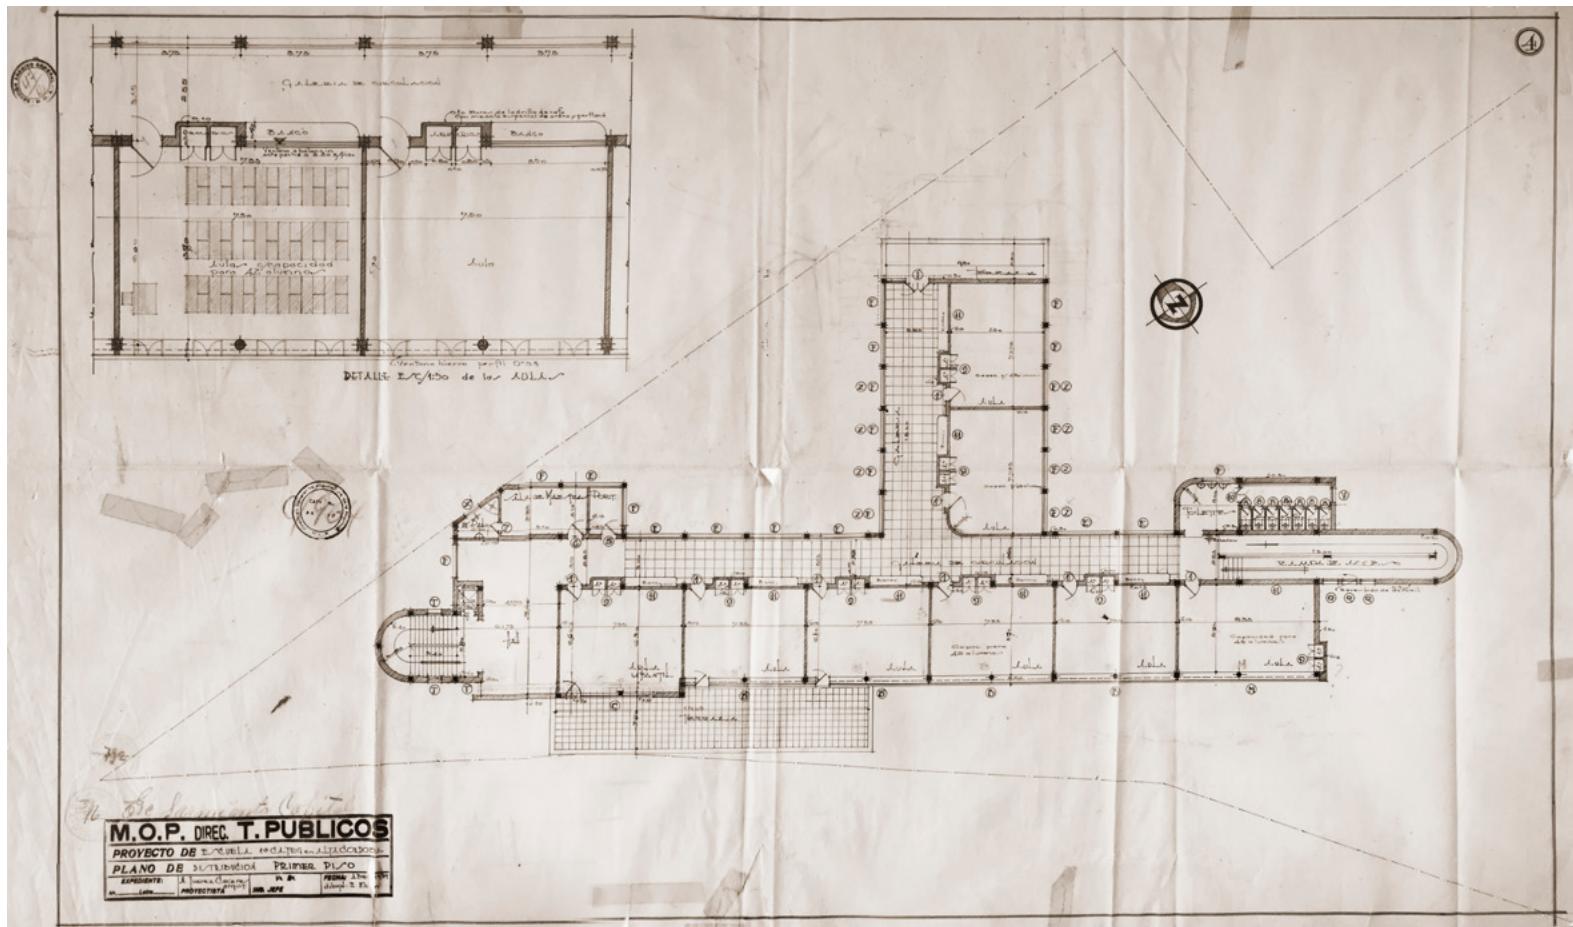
Escuela Presidente Sarmiento. Planta primer piso (Archivo de la Secretaría de Arquitectura de la Provincia de Córdoba).
